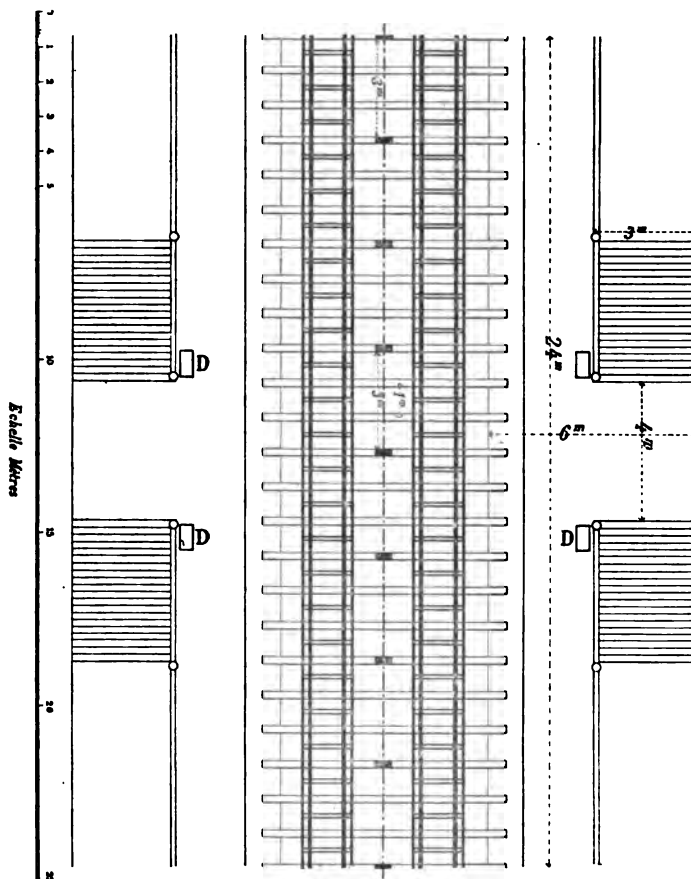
VUE EN PLAN. — Disposition d'une station d'attente.
